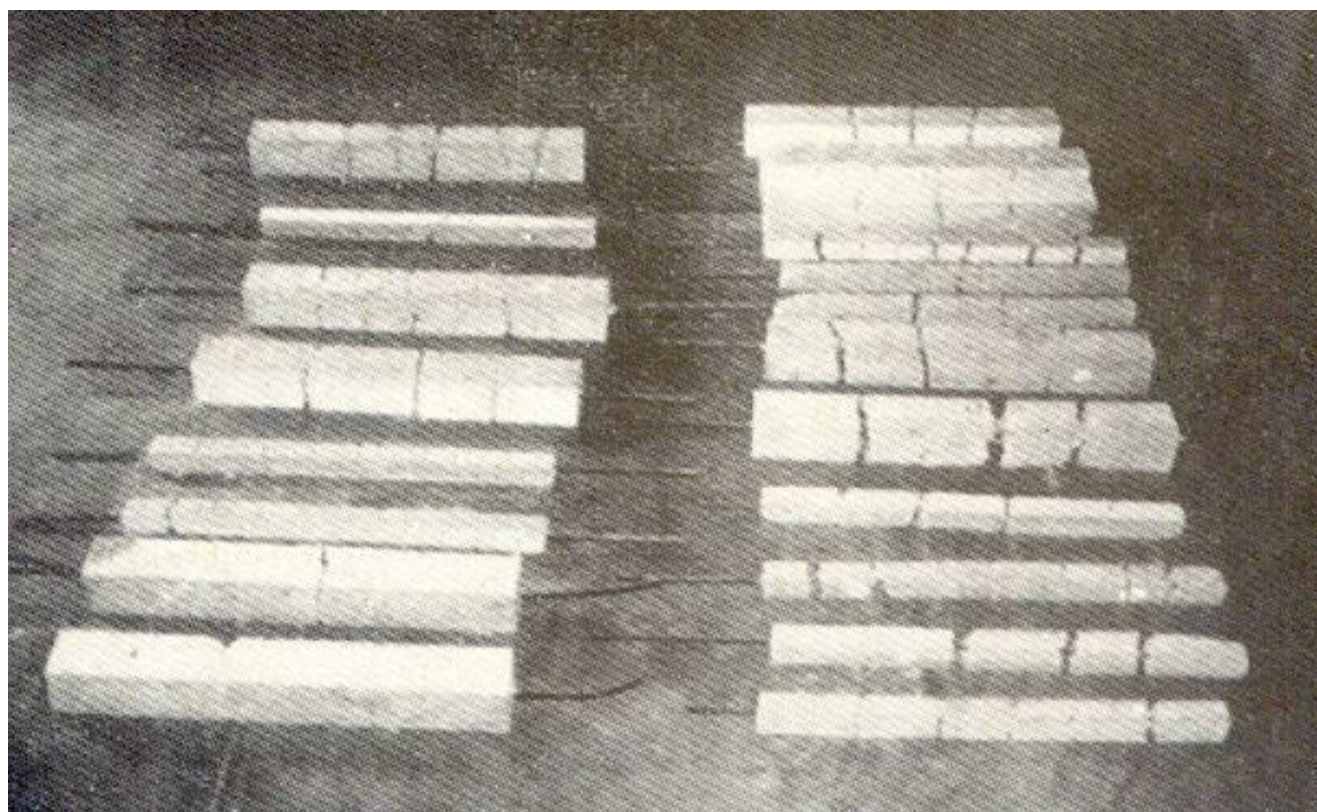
Tirantes de concreto armado ensaiados no Instituto Nacional de Tecnologia
